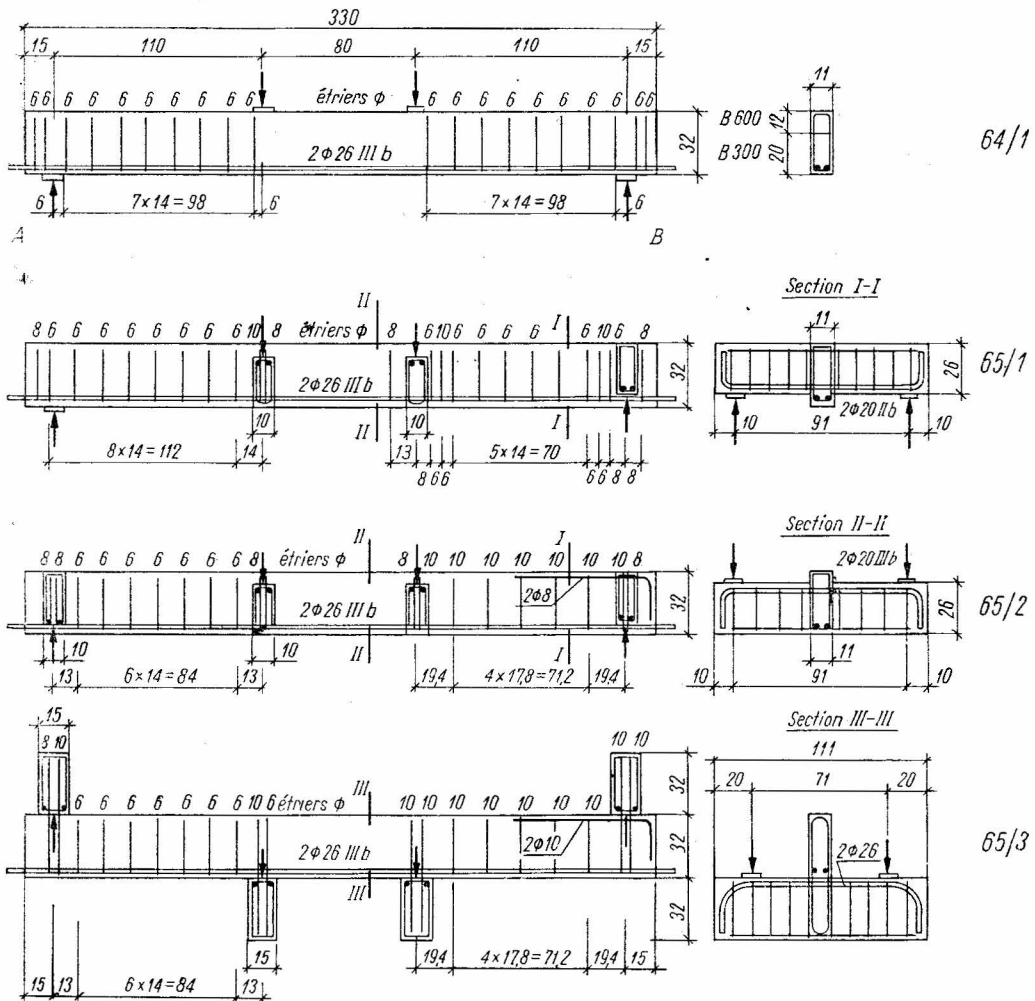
Disposition des charges et des armatures dans les poutres 64/1, 65/1, 65/2 et 65/3
